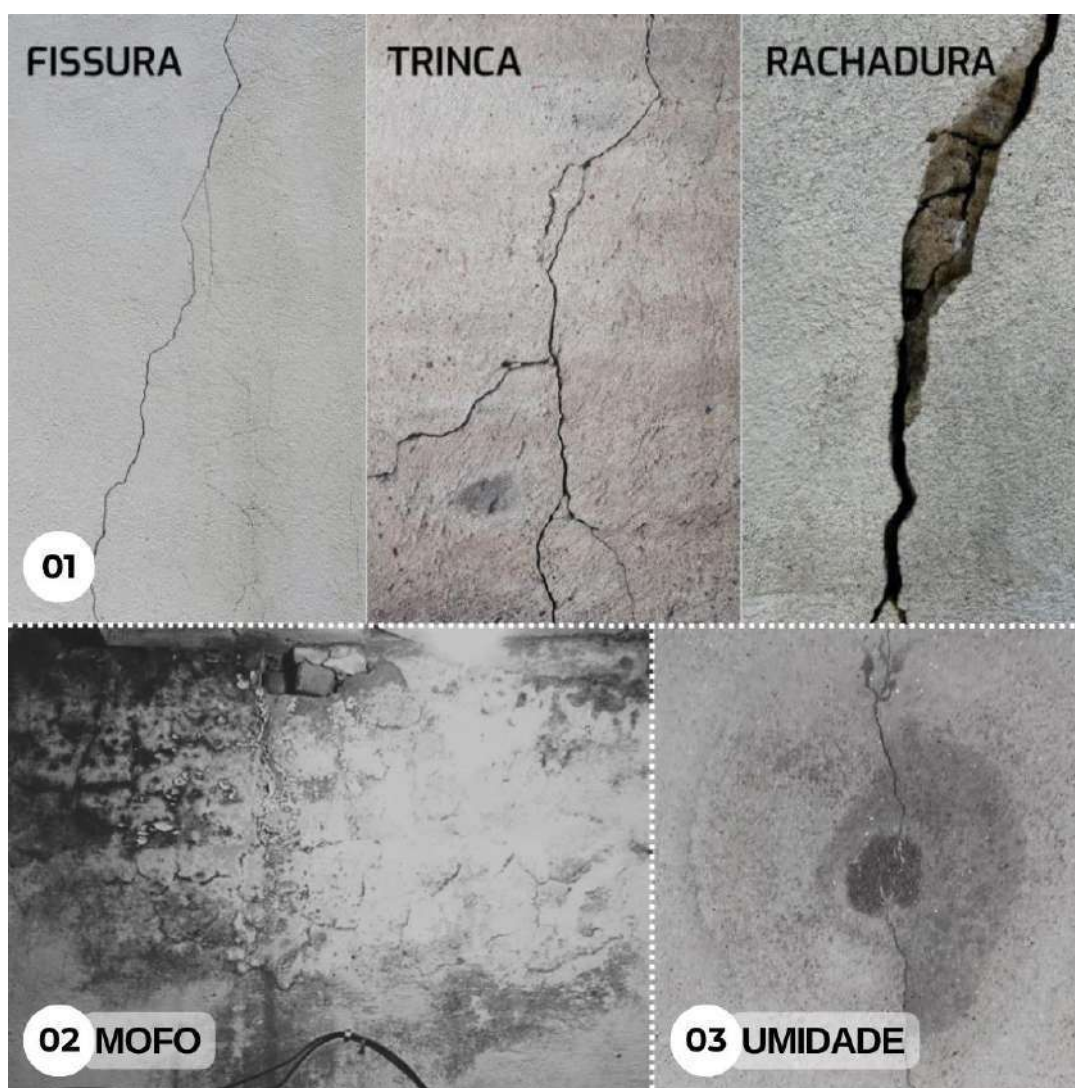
Fissura, trinca e rachadura. Dallminas, 2020 (<https://www.dallminas.com.br/fissuras-trincas-e-rachaduras/>). Figura 02 – Mancha de mofo na parede. Acervo pessoal, 2023. Figura 03 – Mancha de umidade na parede. Acervo pessoal, 2023.
